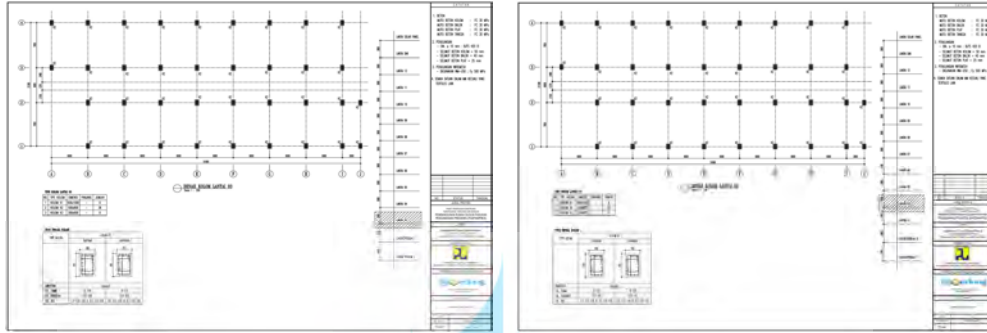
5 Detail struktur balok lantai 10 dan 11
